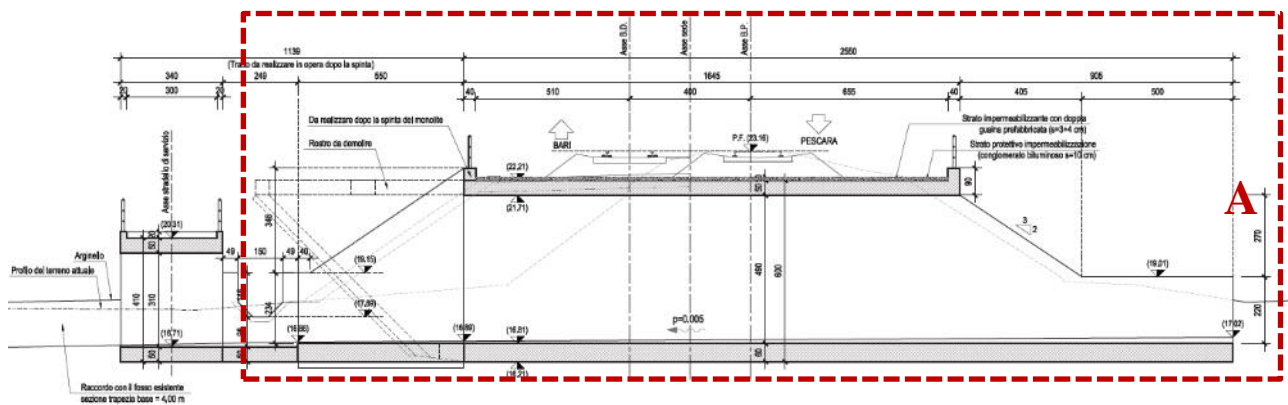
Adeguamento idraulico Fosso Capoposta - Sezione Longitudinale manufatto a spinta
